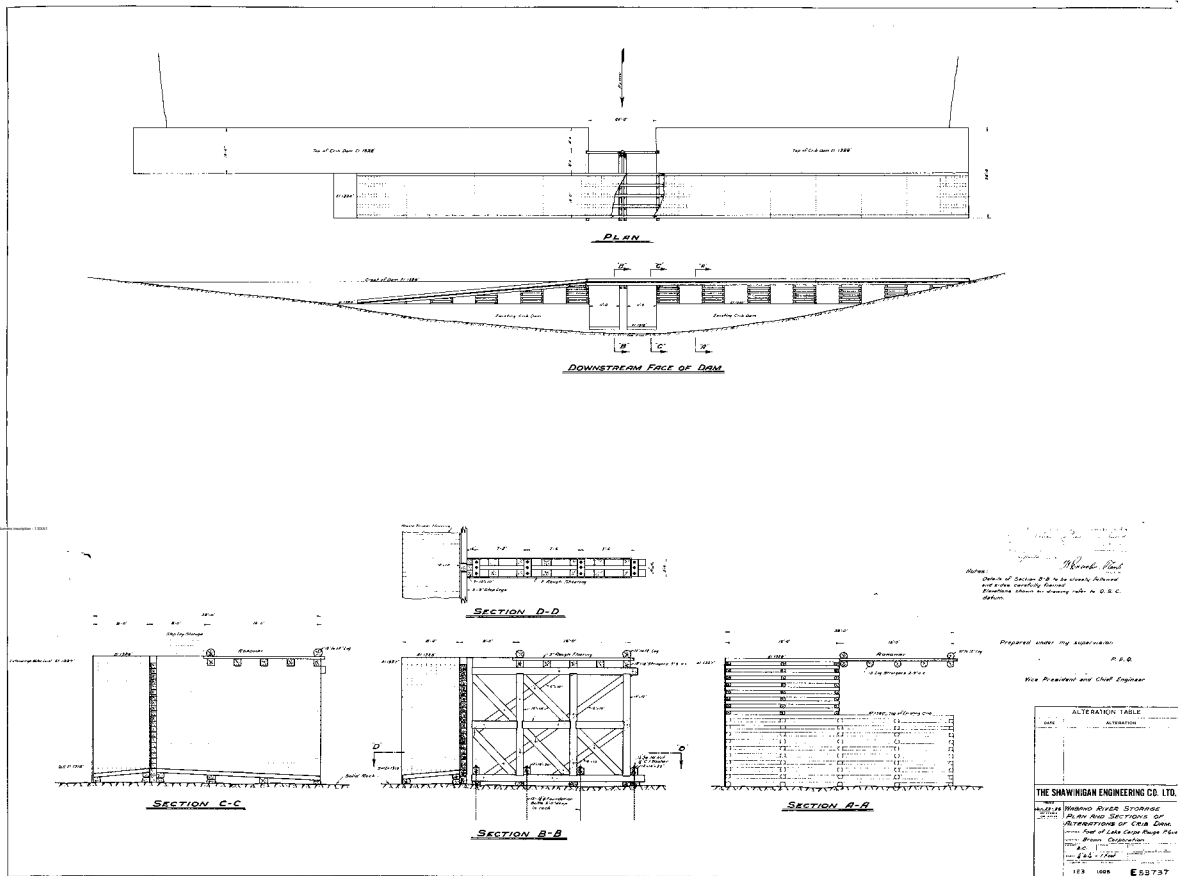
Exemple de barrage à caissons construit par la Brown Corporation
